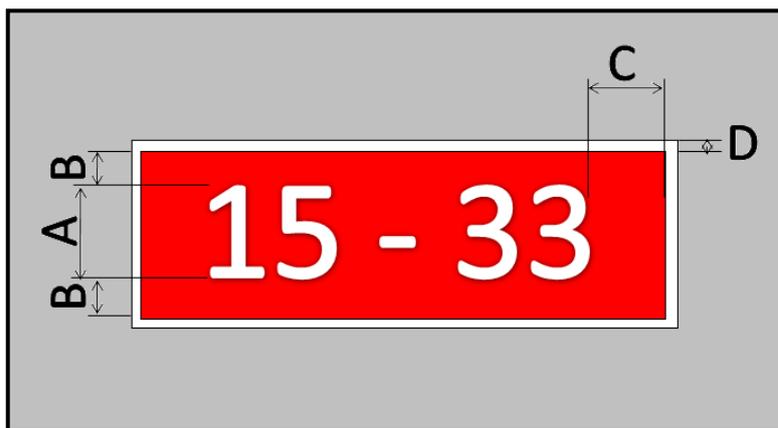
Sinalização horizontal de instrução obrigatória com as dimensões internas
